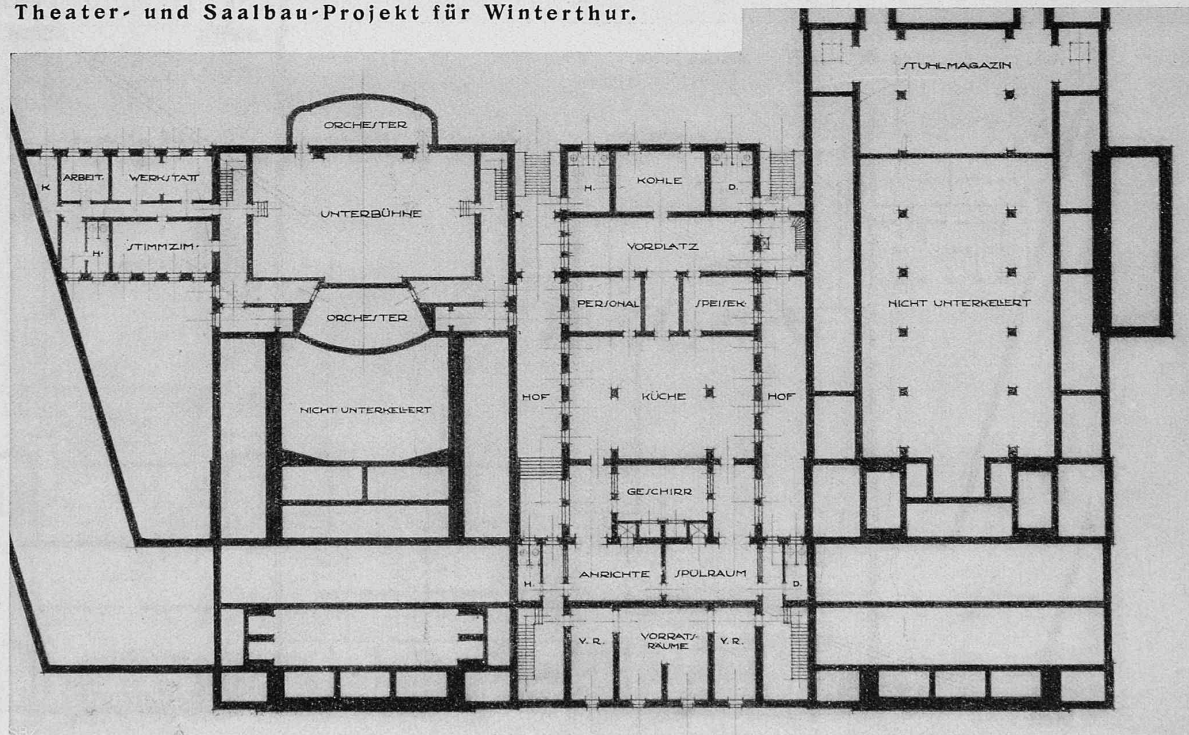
Grundriss vom Untergeschoss. — Masstab 1 : 600.
